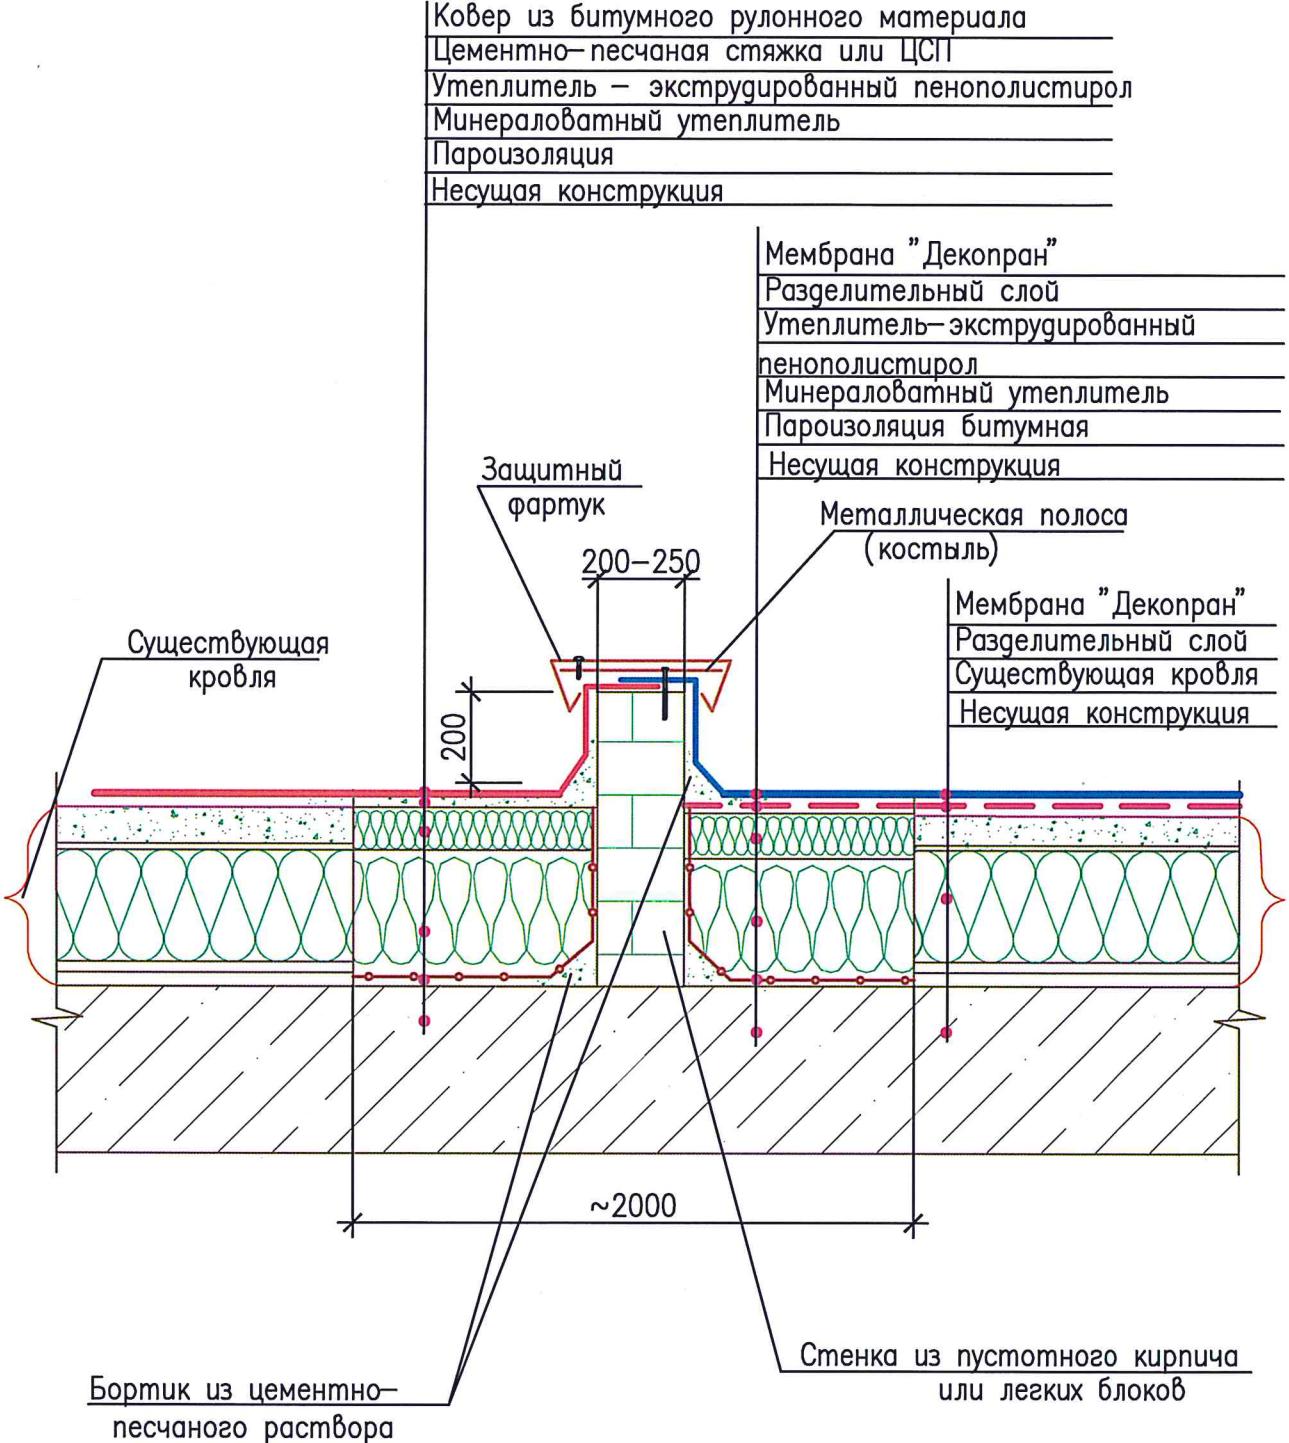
Конструктивное решение ремонта битумной рулонной кровли (переход со старой битумной кровли на кровлю из мембранны "Декопран")
